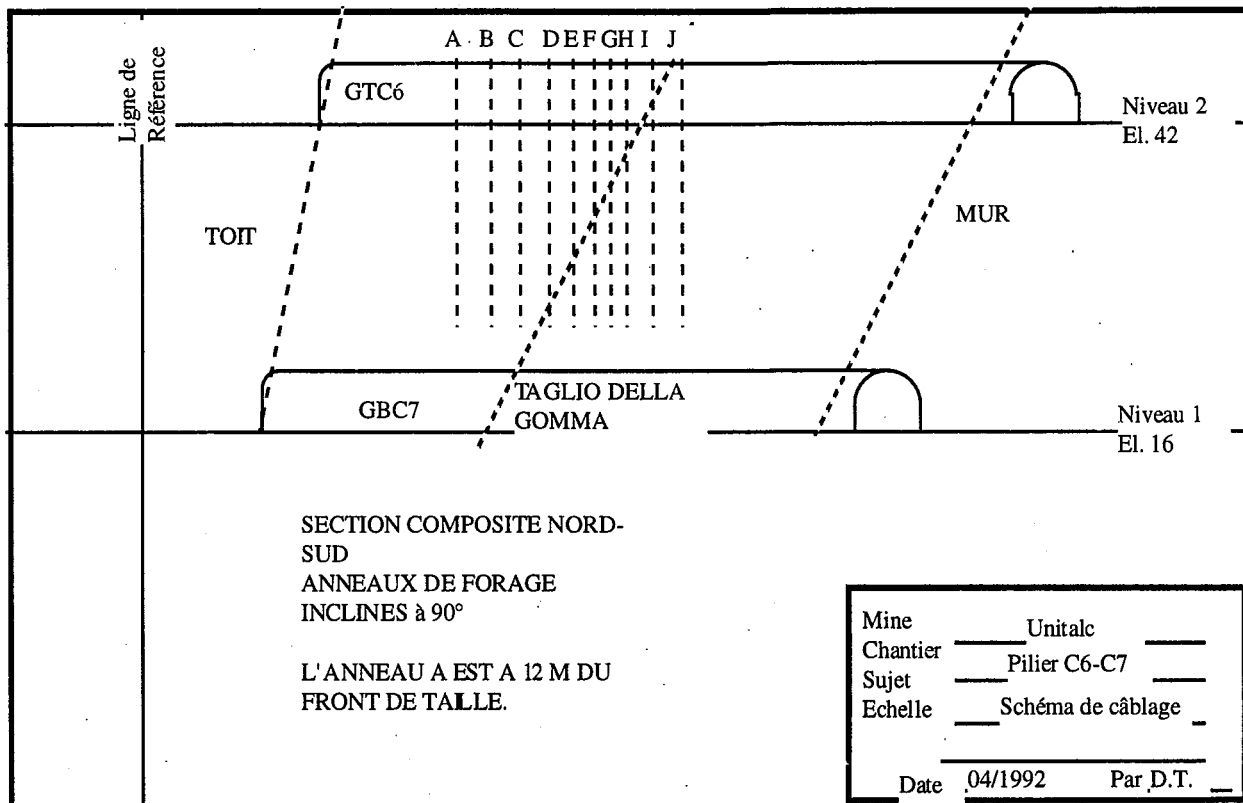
Section verticale parallèle à l'axe d'allongement du pilier C6/C7 montrant le schéma retenu de renforcement à partir de la galerie GTC6
